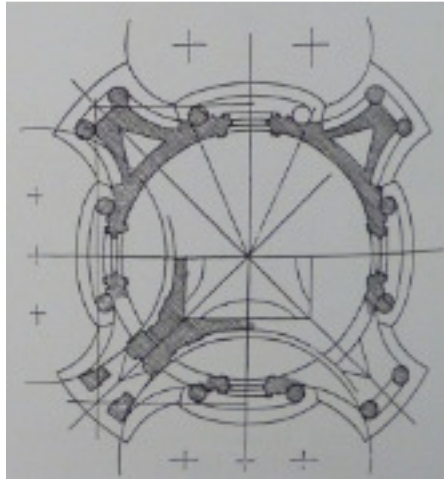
, Francesco Borromini, Grundriss des Vierungsturms von S. Andrea delle Fratte, Rom.
